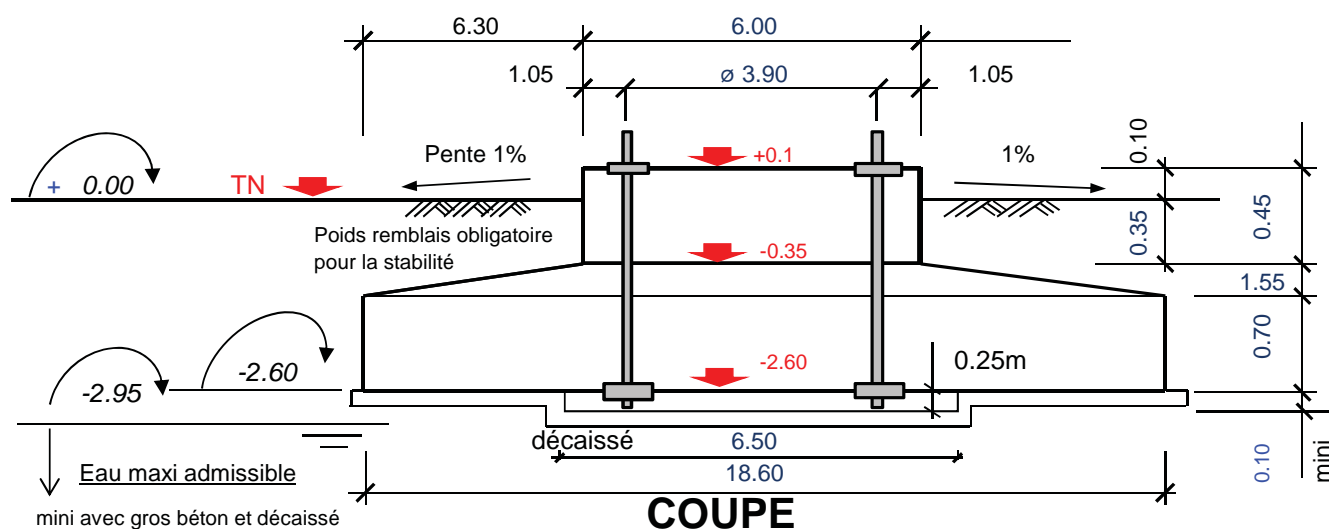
Exemple de plan de fondation superficielle d'une éolienne VESTAS V112-3.3MW (source : CTE, bureau d'étude génie civil)
